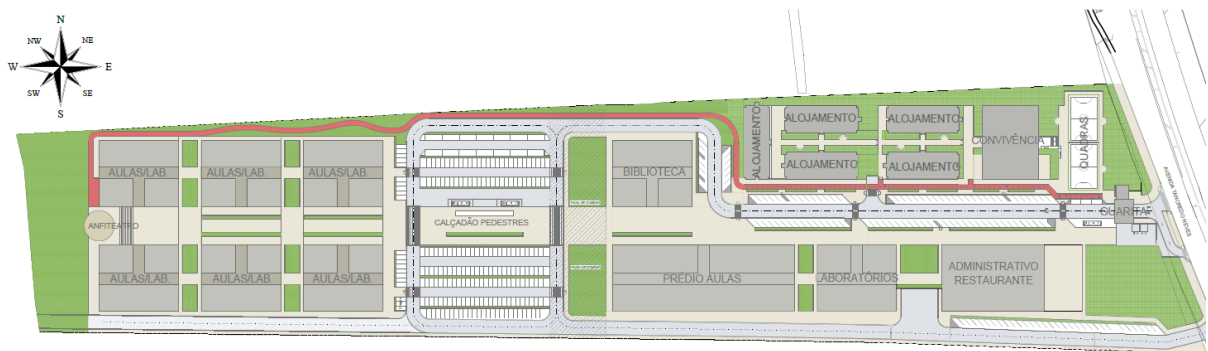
Proposta de Implantação para o terreno da UNILA, anexo à construção do Alojamento estudantil.
